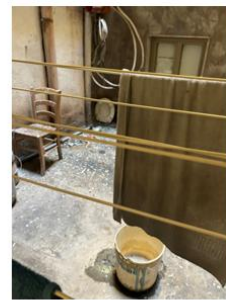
SUB 78 - Vanella nella quale prospetta la finestra dell'Ambiente n.2
